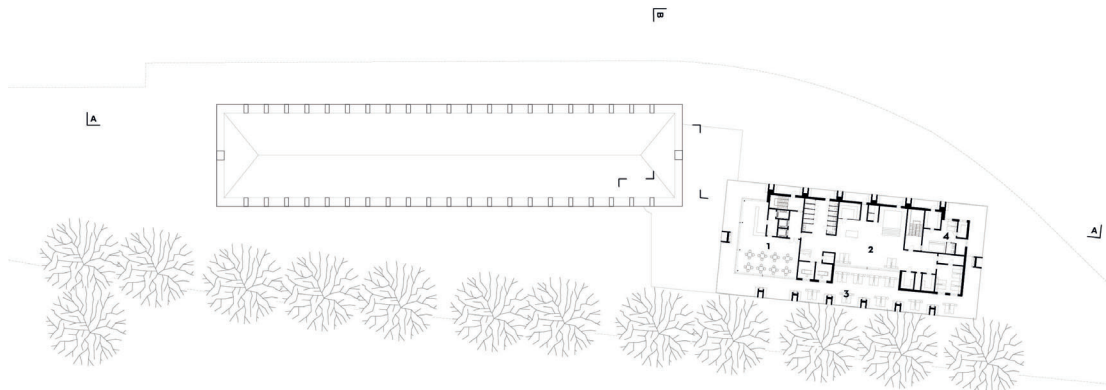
Dachaufsicht Längsbau, oberstes Mansardengeschoss Kopfbau (Niveau 5)
